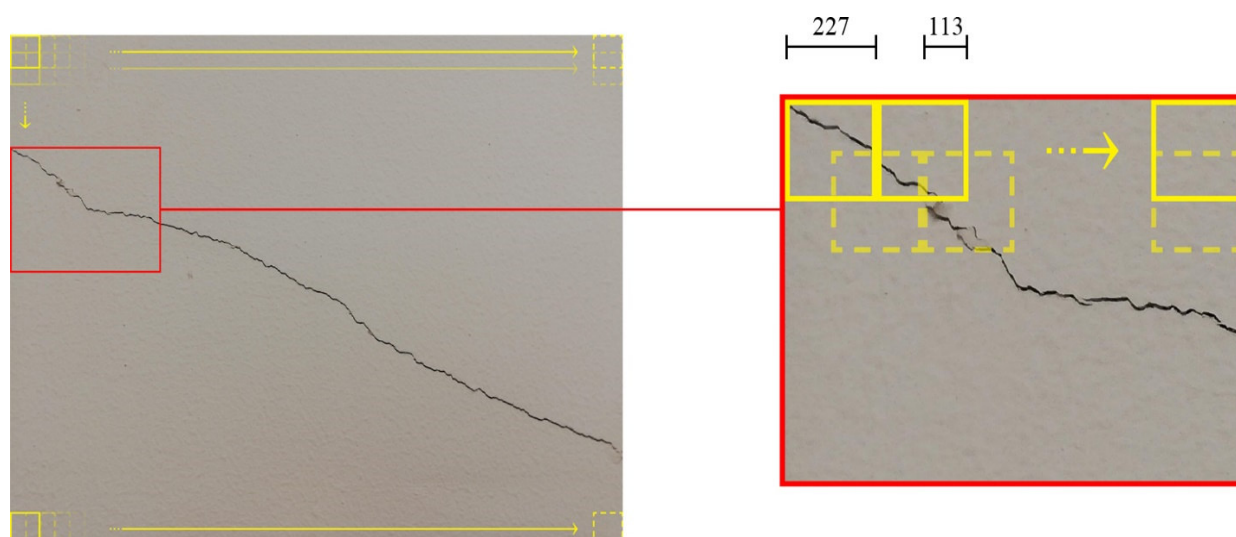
Stride* na detecção das fissuras (ISEP, 2020)
